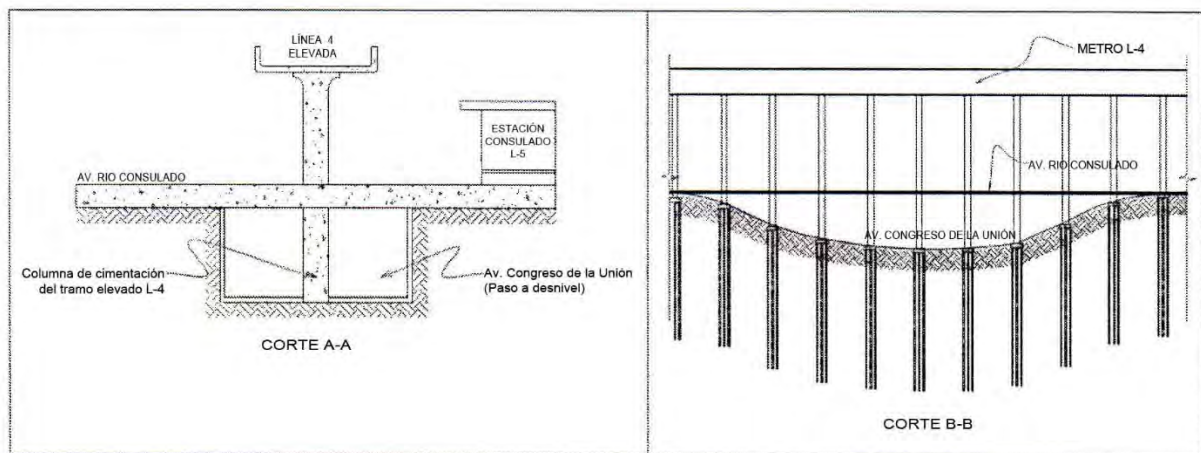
Cortes del cruce de las Av. Congreso de la Unión y Río Consulado.
